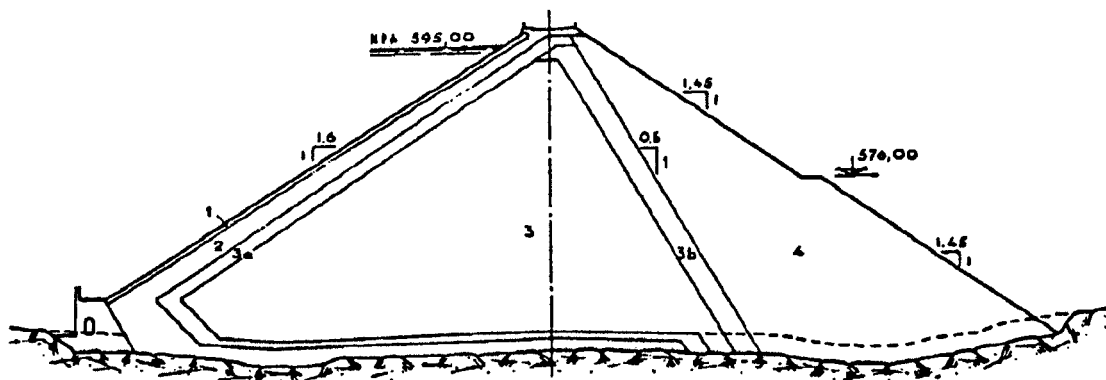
Perfil tipo da barragem da Apartadura (Gonzalez e Rodrigues, 1988).
